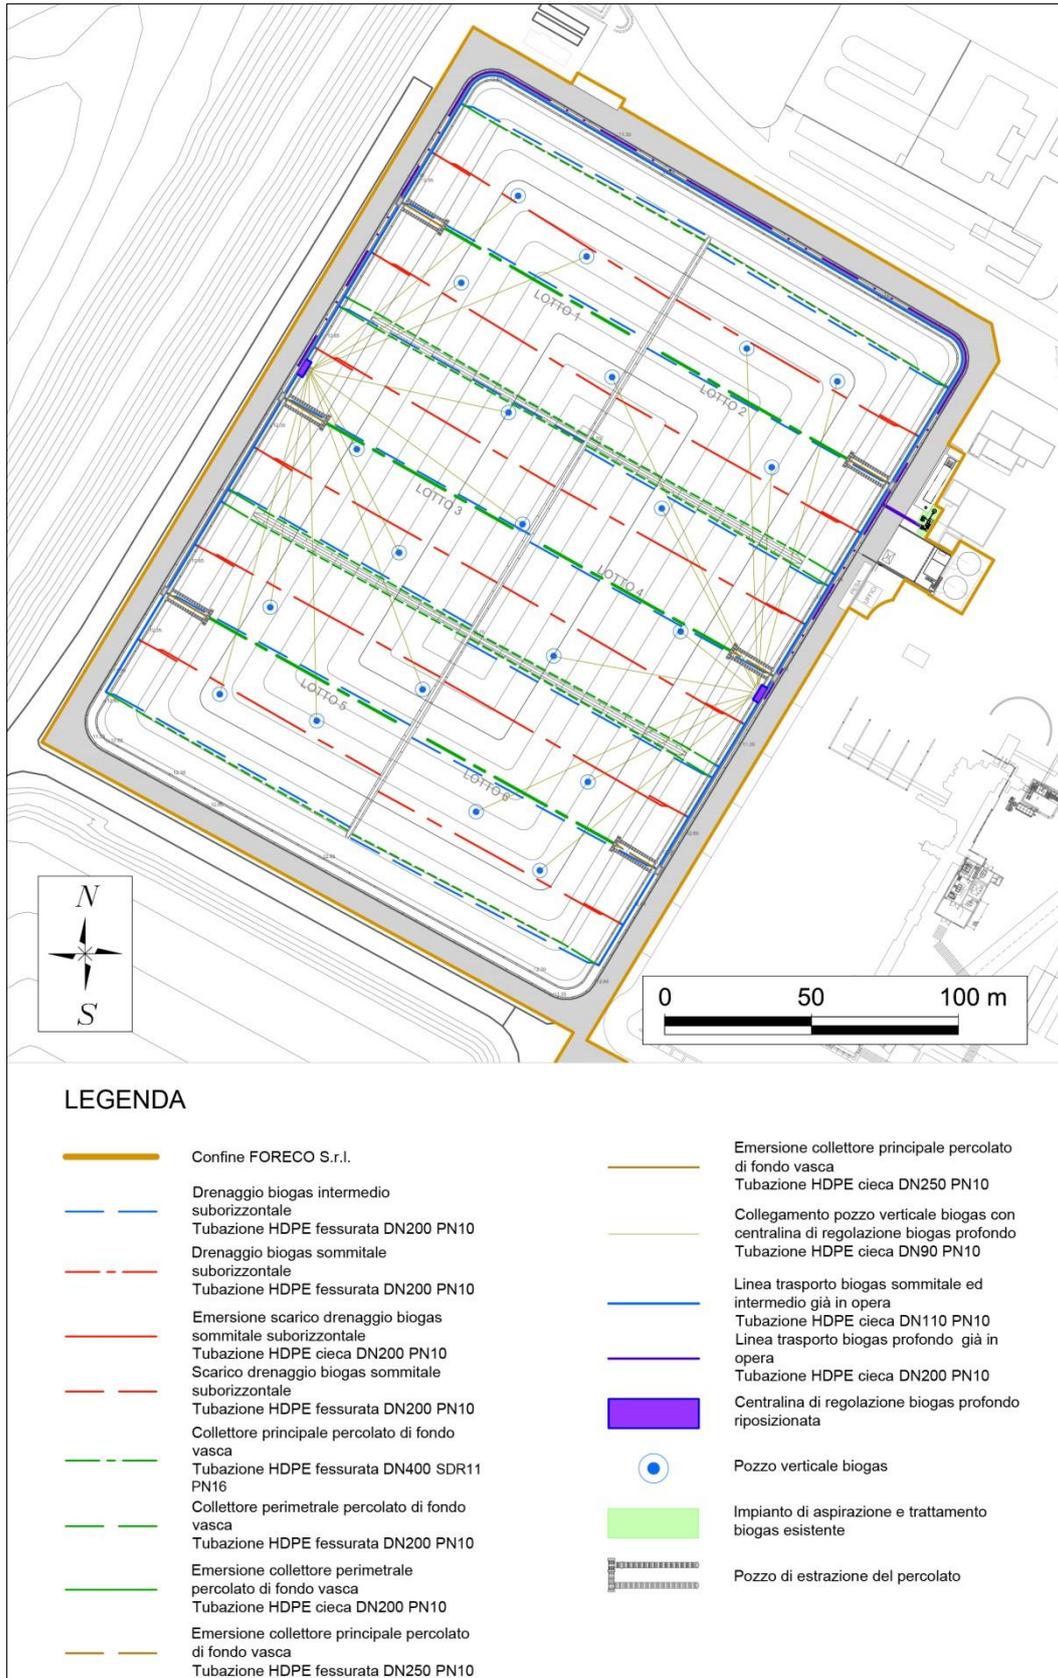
2 – Planimetria schematica sistema di captazione del biogas
